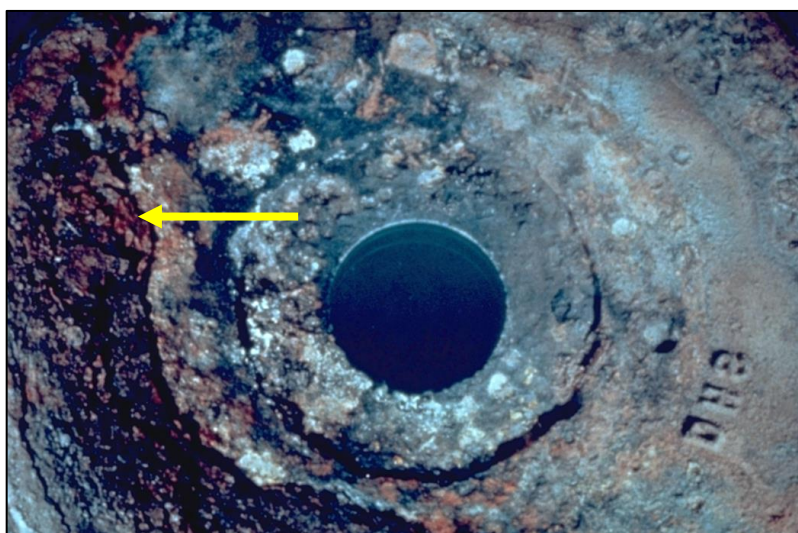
Tubo de aço e cobre sob processo de desgaste corrosivo geral e galvânico.
